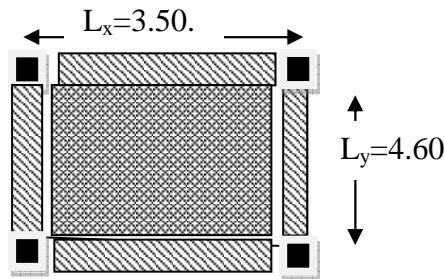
Schéma de la dalle pleine reposant sur deux appuis (D3).
